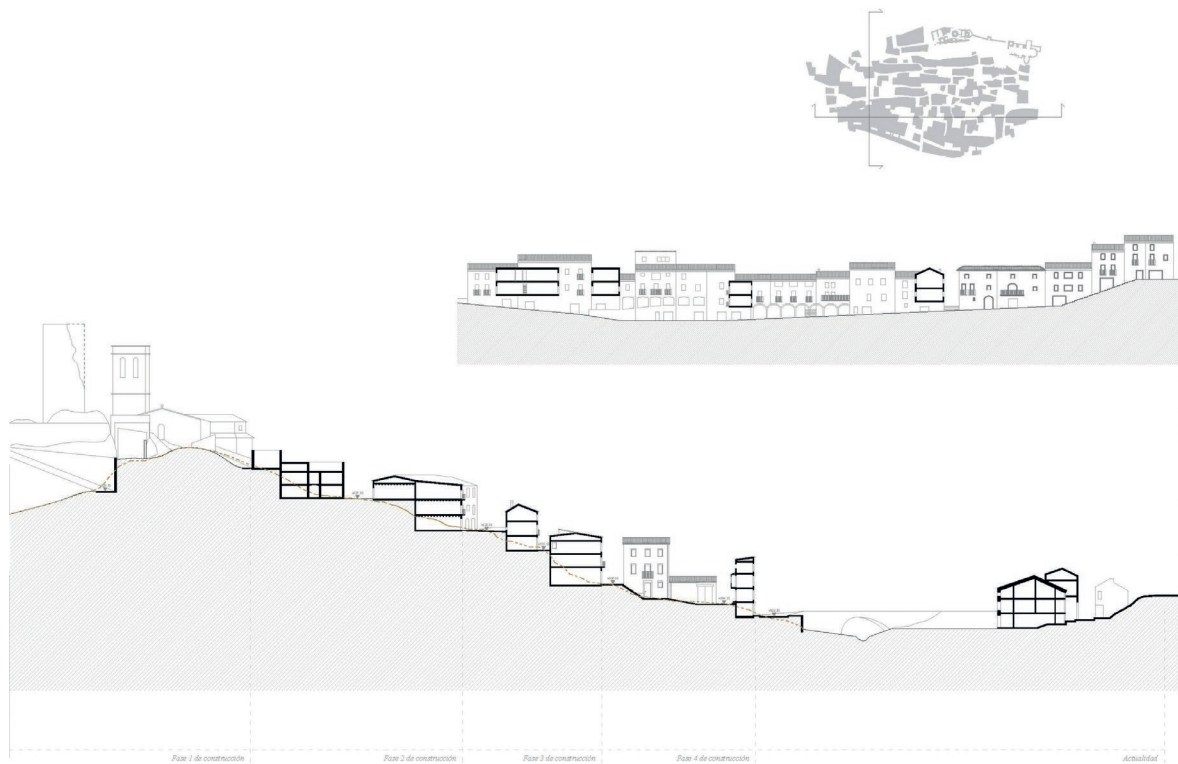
Sección transversal y tramo de sección longitudinal en la que se muestra una calle con tipología de viviendas puente.
